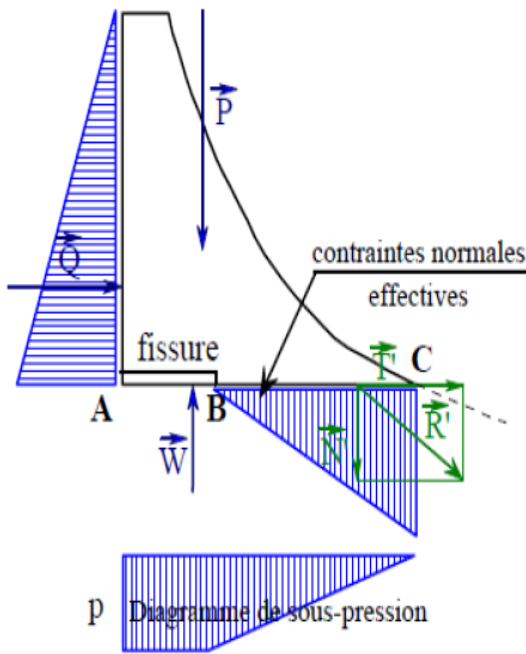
Equilibre avec fissuration. [SIT]
